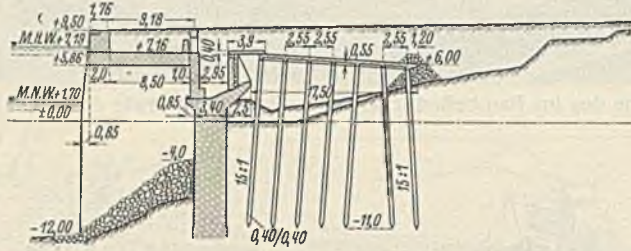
Le Havre. Joannes-Couvert-Kai (Gewölbebauweise). Nachträglich eingebaute Entlastungsplatte an der Westseite der Kaimauer. Querschnitt.
